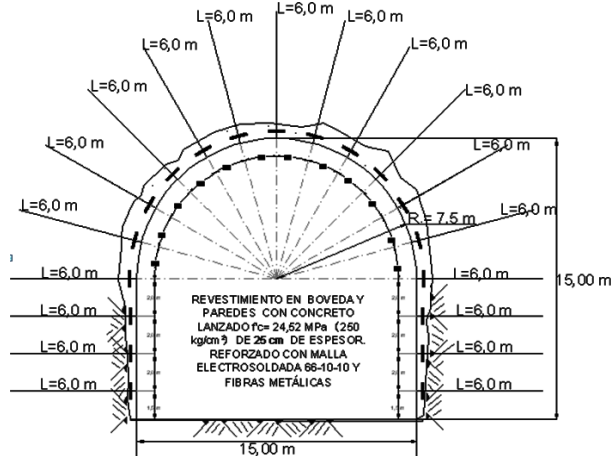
Tratamientos propuestos a lo largo del túnel, excepto en emportalamientos y cruce con fallas geológicas. Sección de anclaje y concreto lanzado. Secciones @ 2,0 m
